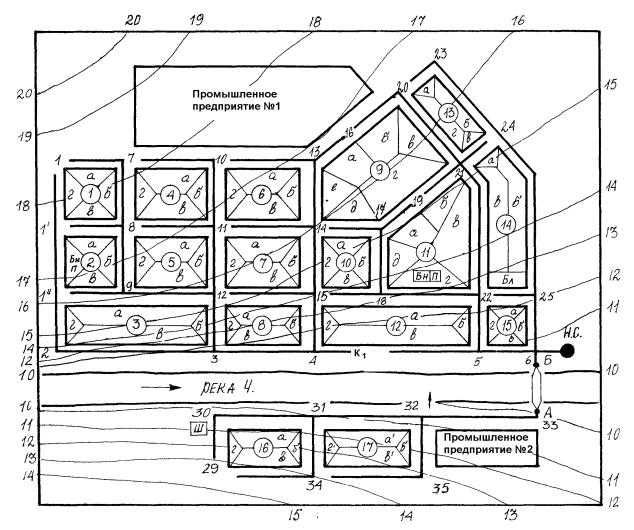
Схема водоотводящих сетей на генеральном плане города: Б_н — бани; П — прачечные; Б — больница; Г — автопредприятие; НС — насосная станция; ОС — очистные сооружения; — к₁ — производственно-бытовая сеть
